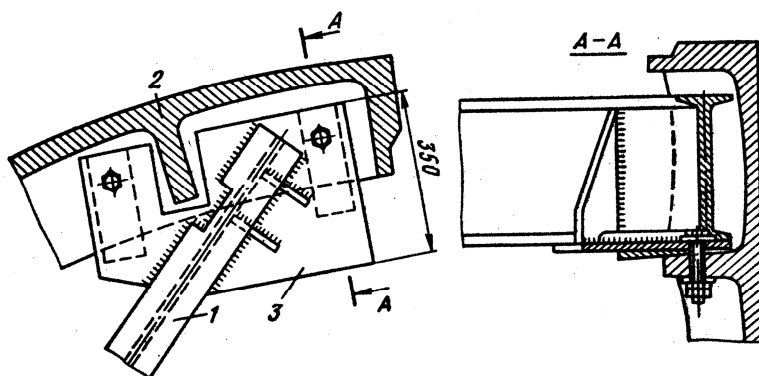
Схемы закрепления расстрелов при тьюбинговой крепи: 1 - расстрел, 2 - полка тьюбинга, 3 - металлические косынки
